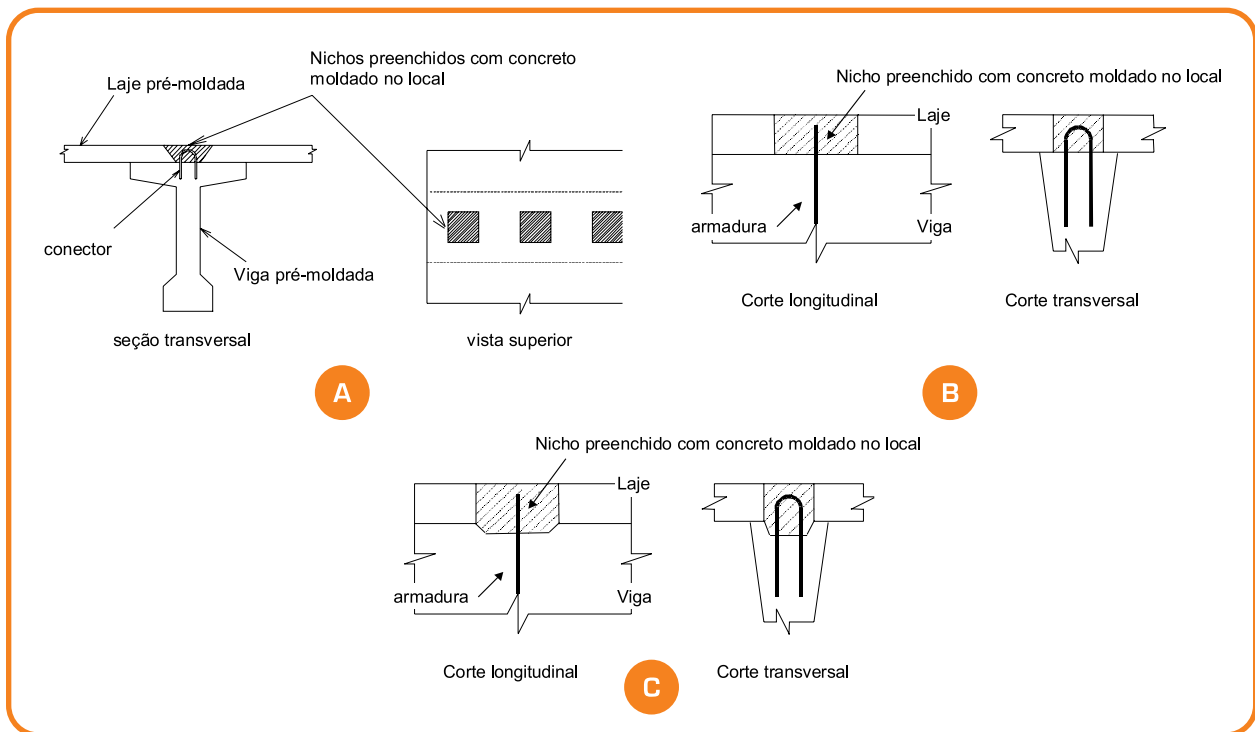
Ligação de viga e laje pré-moldadas com nichos preenchidos de concreto a) tipo de ligação, b) alternativa usual com de preenchimento concreto normal e c) alternativa proposta com chave e preenchimento com concreto de alta resistência e fibras de aço [ARAUJO (2002)]
